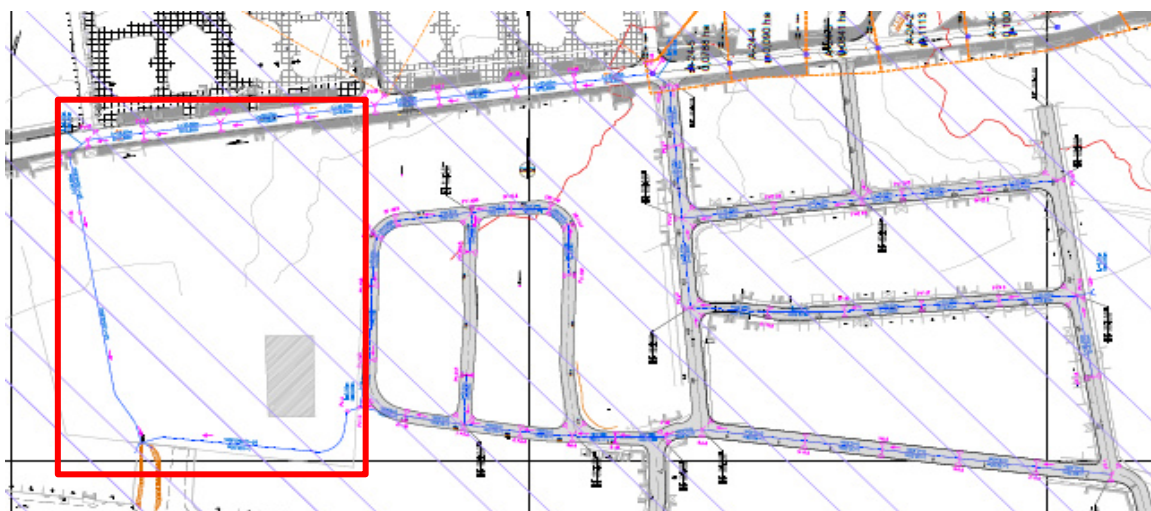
Edificação existente e habitada localizada na área de construção do Booster
